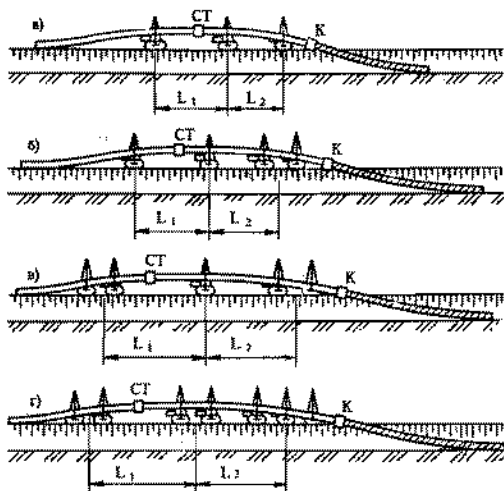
Схемы расположения трубоукладчиков и машин в изоляционно-укладочной колонне при совмещенном способе производства работ для трубопроводов различных диаметров при использовании комбайнов: а - 529 - 820 мм; б - 1020 мм; в - 1220 мм; г - 1420 мм; СТ - сушильная установка; К - комбайн для очистки и изоляции трубопровода;  $l_1, l_2$  - расстояние между трубоукладчиками и группами трубоукладчиков
